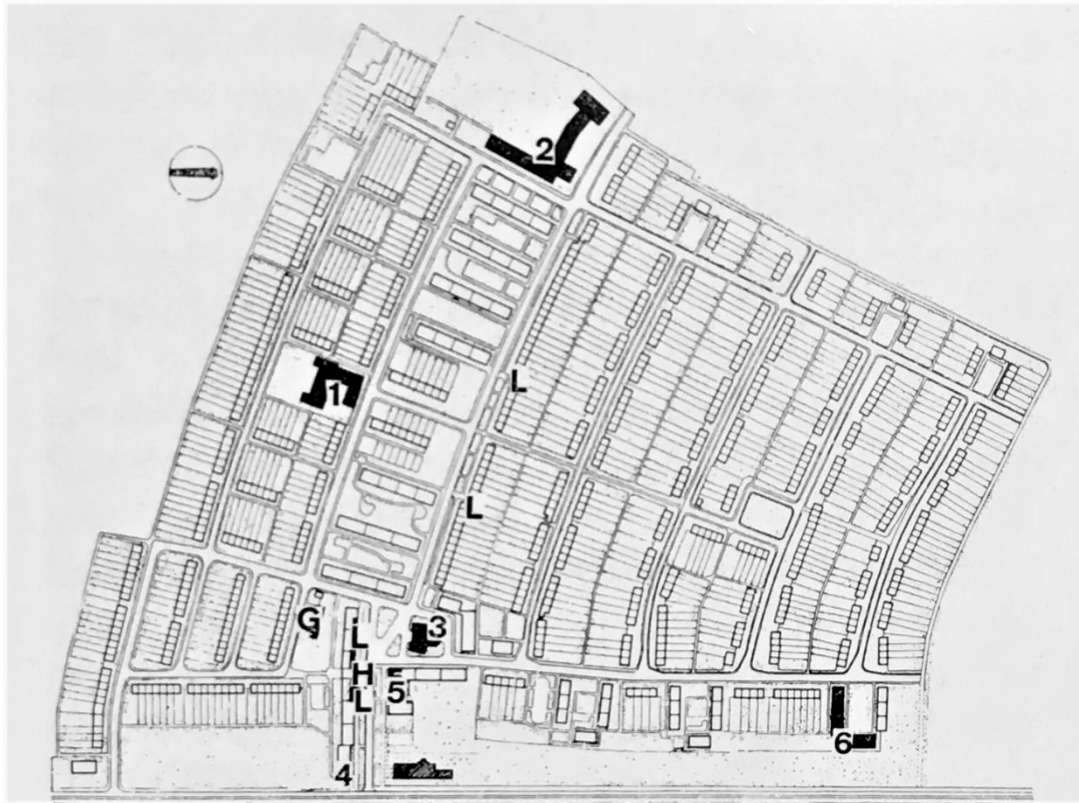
Lageplan der Per-Albin-Hansson-Siedlung West, Erbauung 1947-51 und 1954-55
